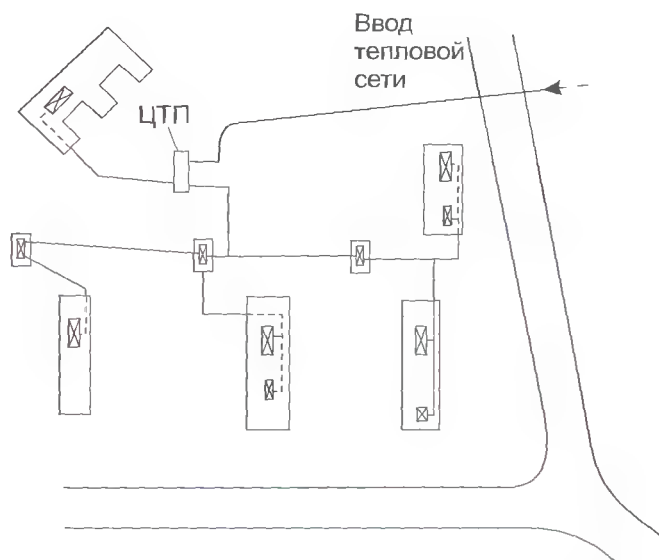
Схема теплоснабжения группы зданий от ЦТП
